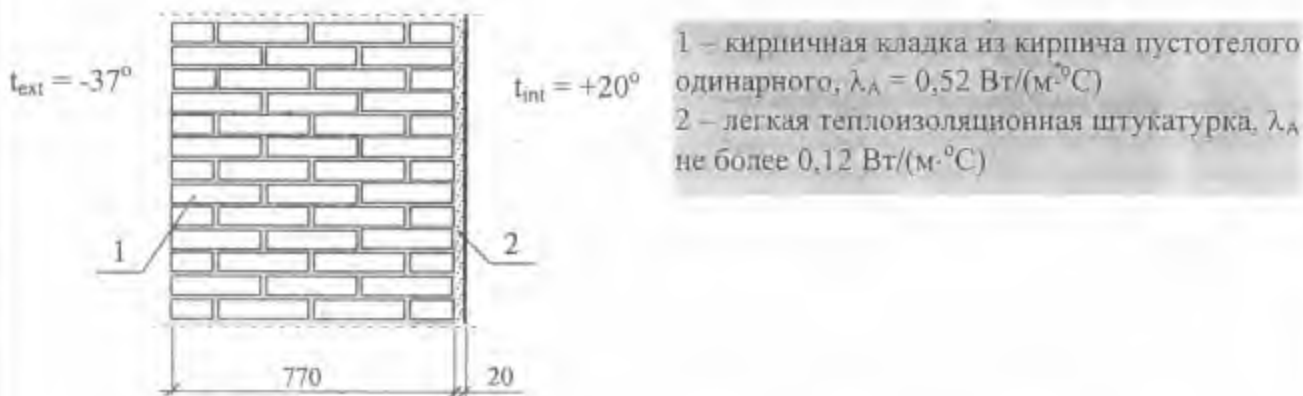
, Схематичный разрез наружной стены проектируемого здания
